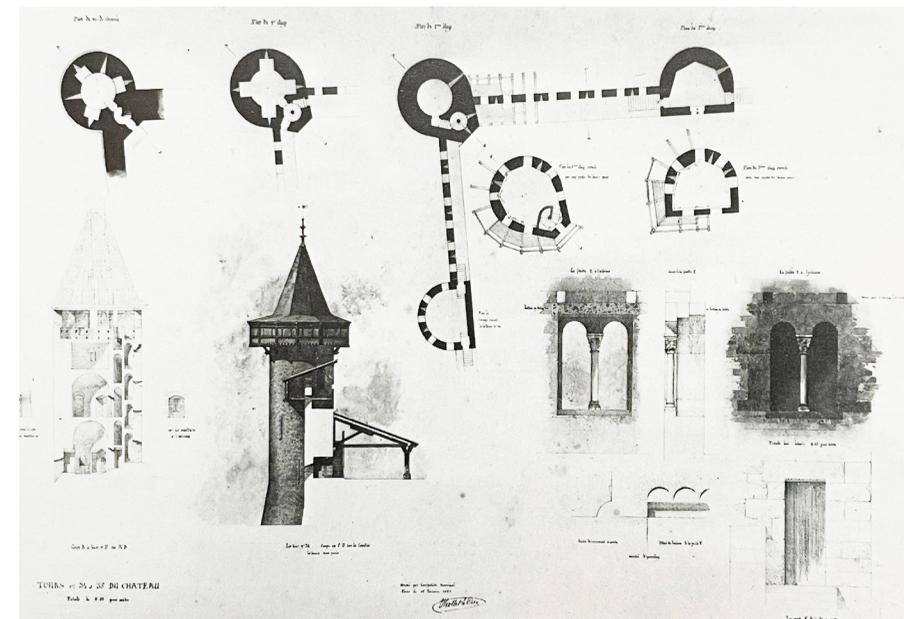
Plano de la planta baja, del primer, del segundo piso, cortes, elevación de la ventana, 15 de enero de 1853
